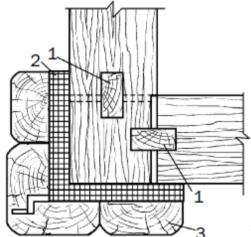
Теплоизоляция углового соединения брусчатой стены: 1
